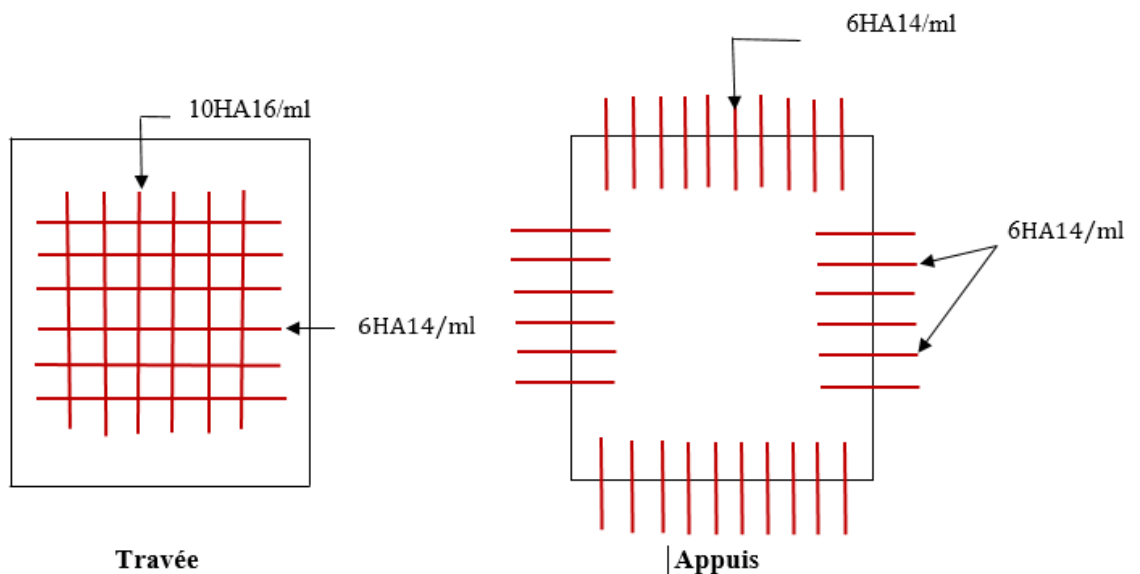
Schéma de ferrailage d'un panneau de rive.
